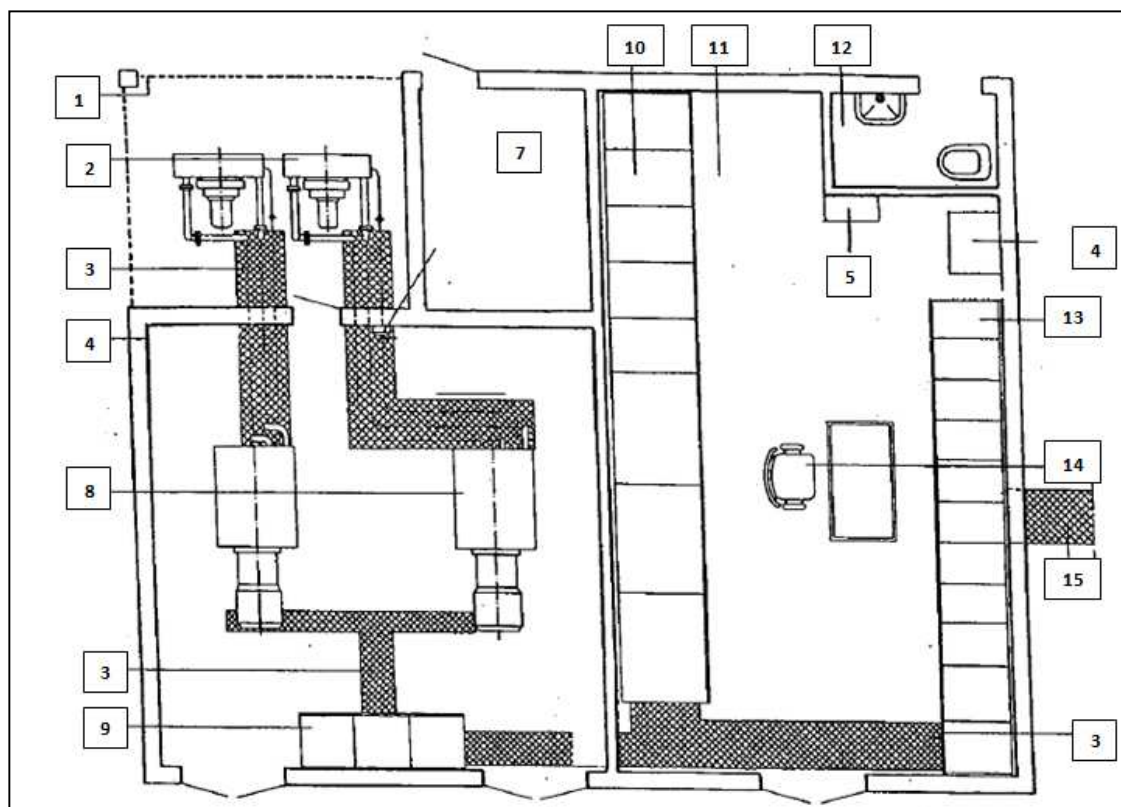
Planimetria impianto di sollevamento Comparto Nord.
